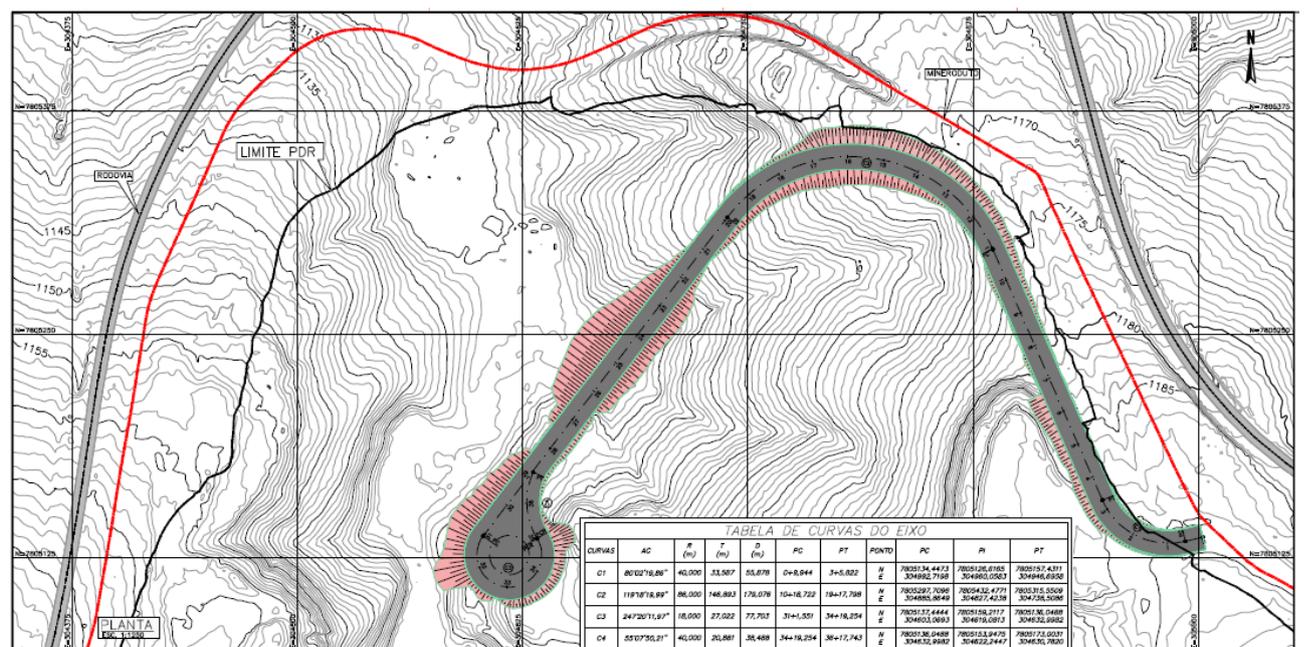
Arranjo geral do acesso construtivo 02, na área de fundação da PDR-1
